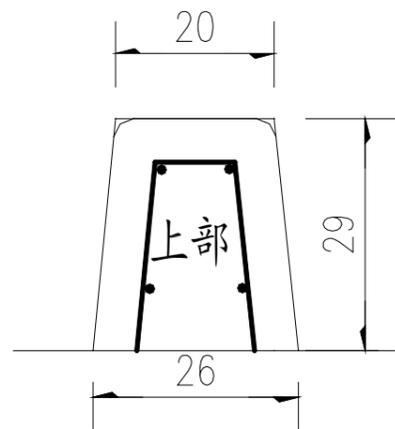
护栏上部 M_{w1} 计算简图 (尺寸单位: cm)
